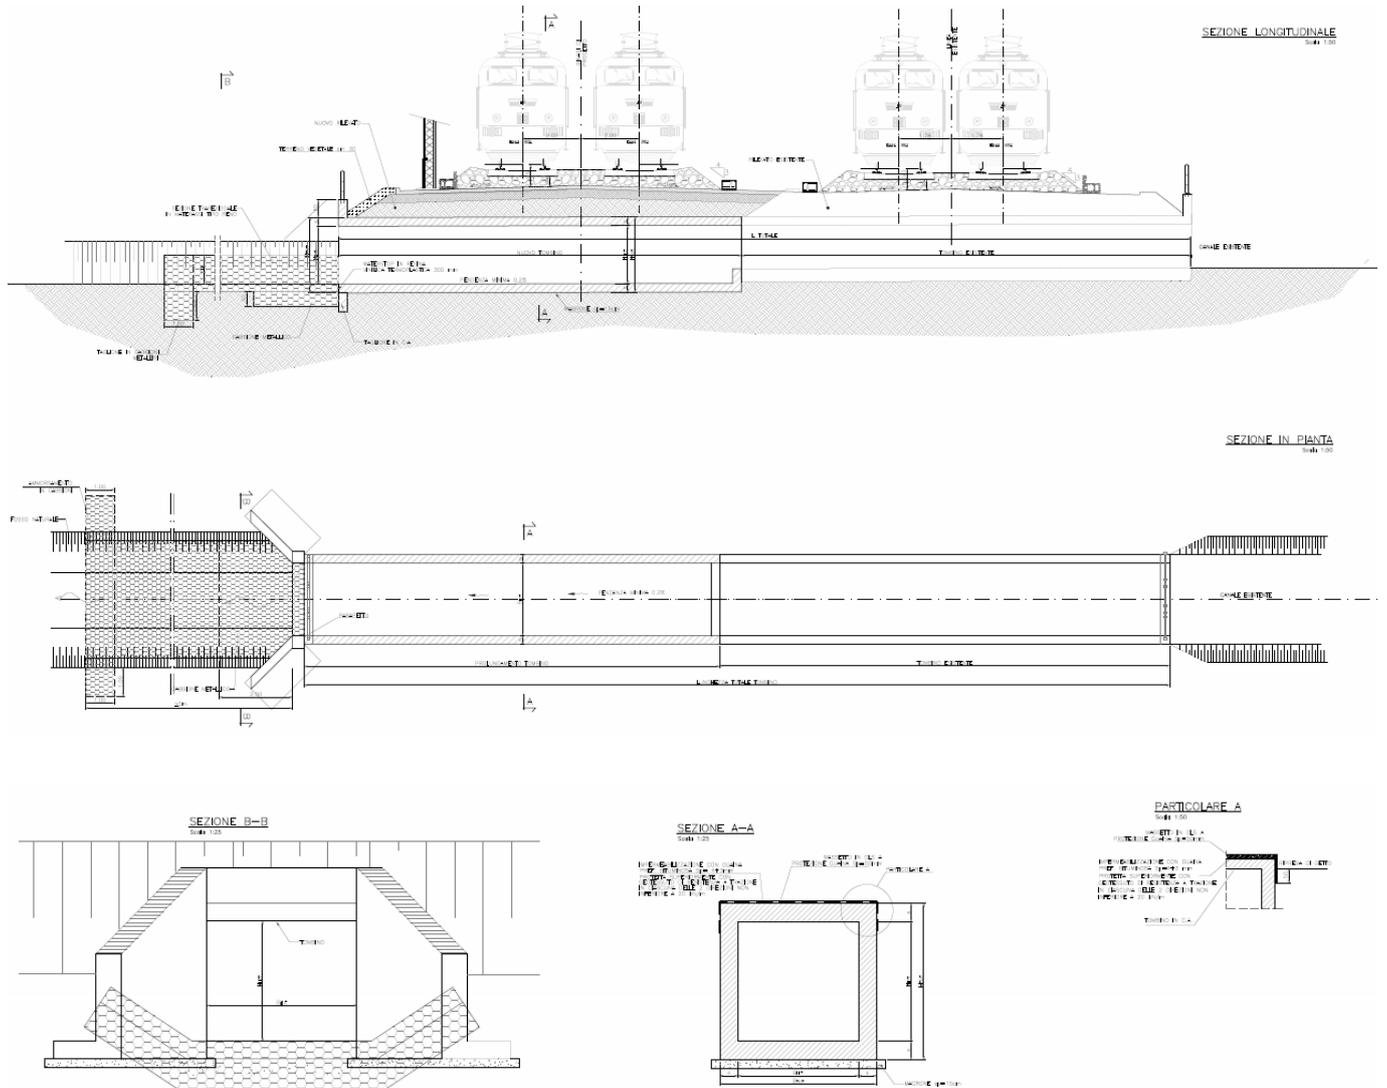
Sezione longitudinale e sezione pianta tombino scatolare
